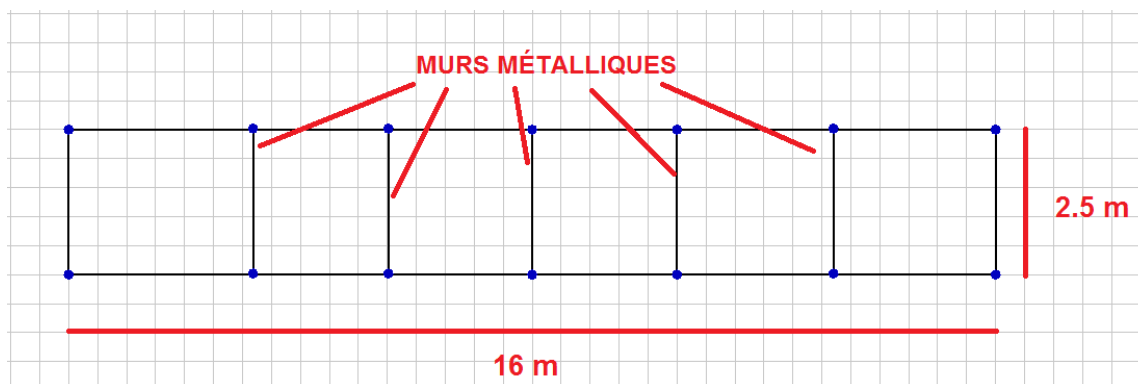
Plan de plancher pour représenter les murs métalliques
